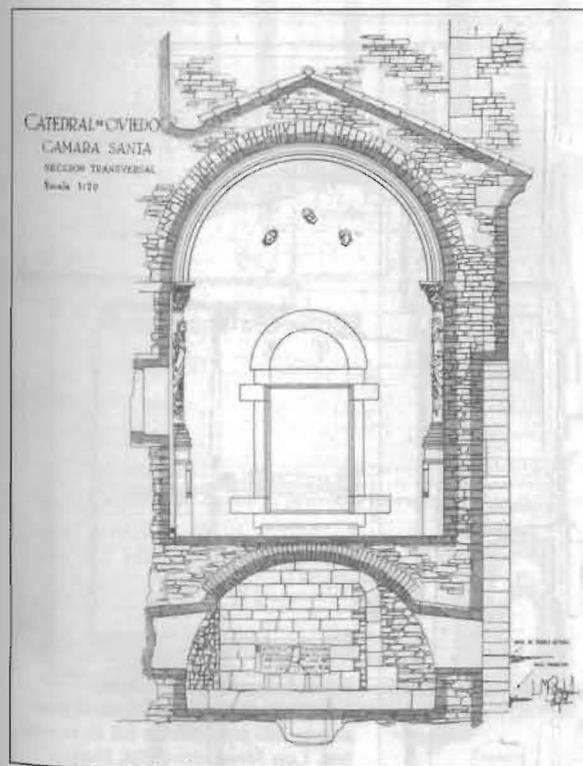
La Cámara Santa de la catedral de Oviedo, sección transversal proyecto de reconstrucción. Luis Menéndez-Pidal, 1940.
